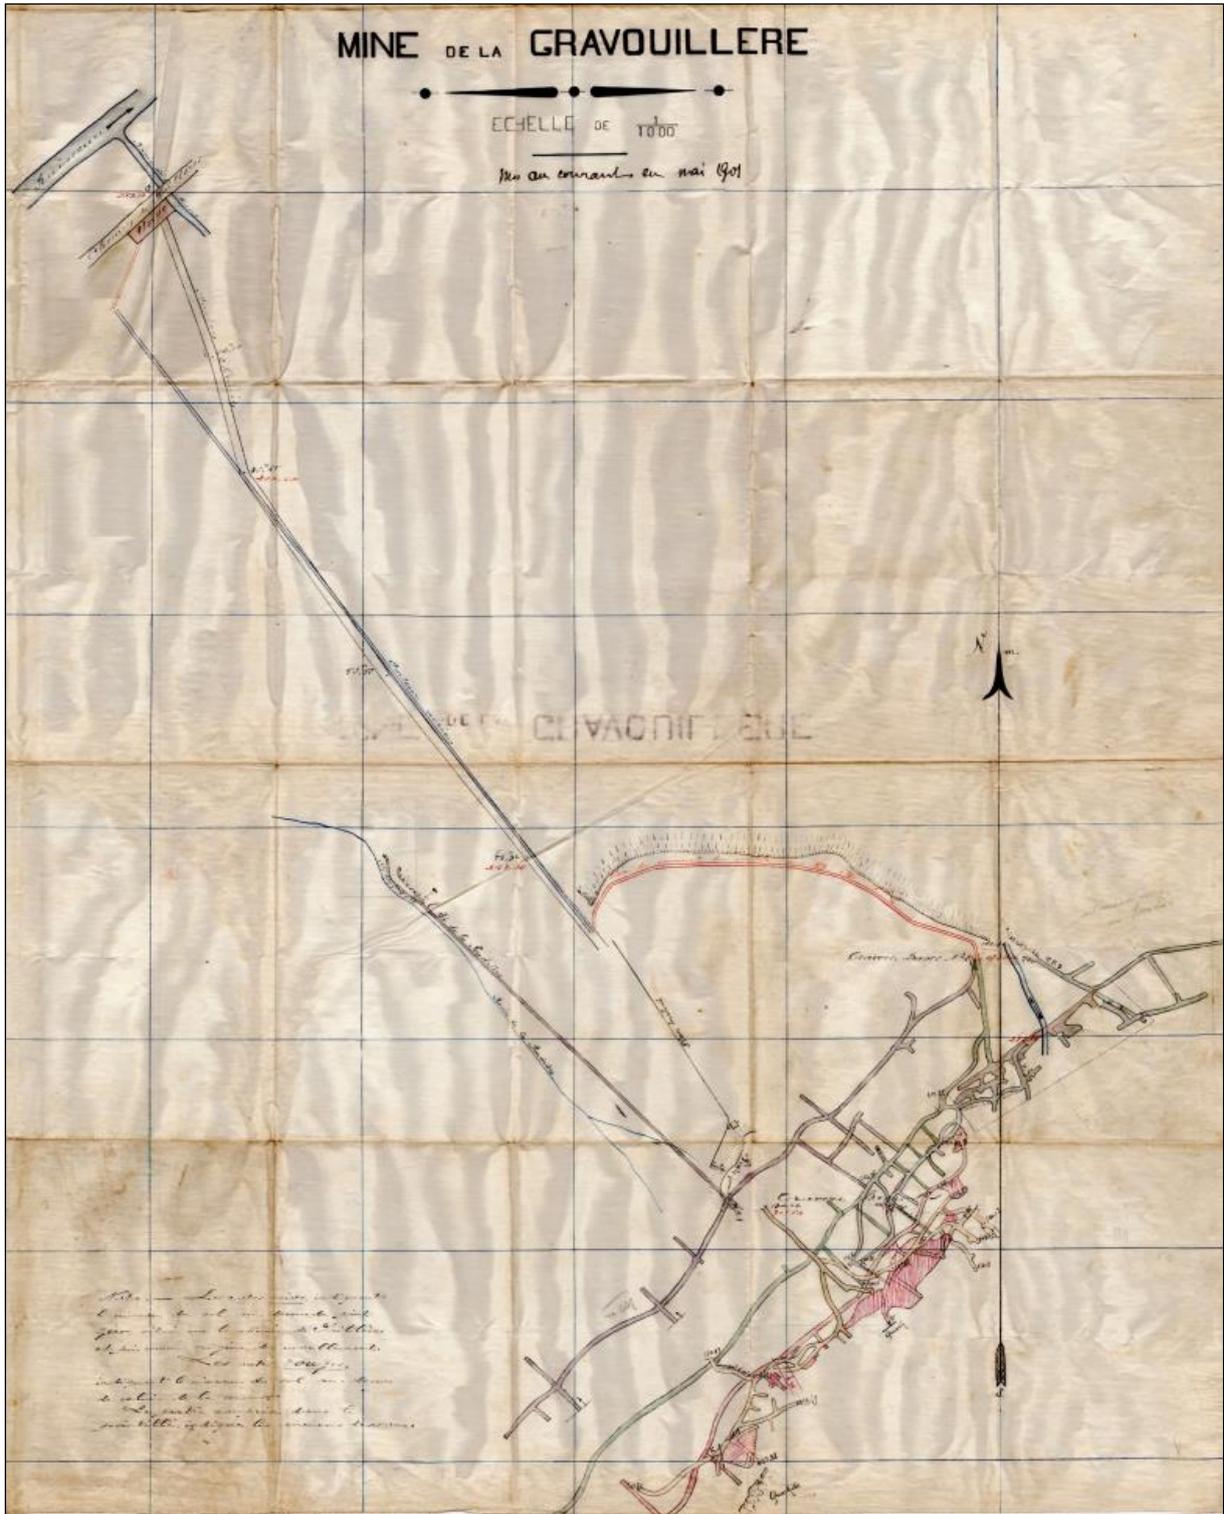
Mine de la Gravouillère, plan des travaux de 1901
